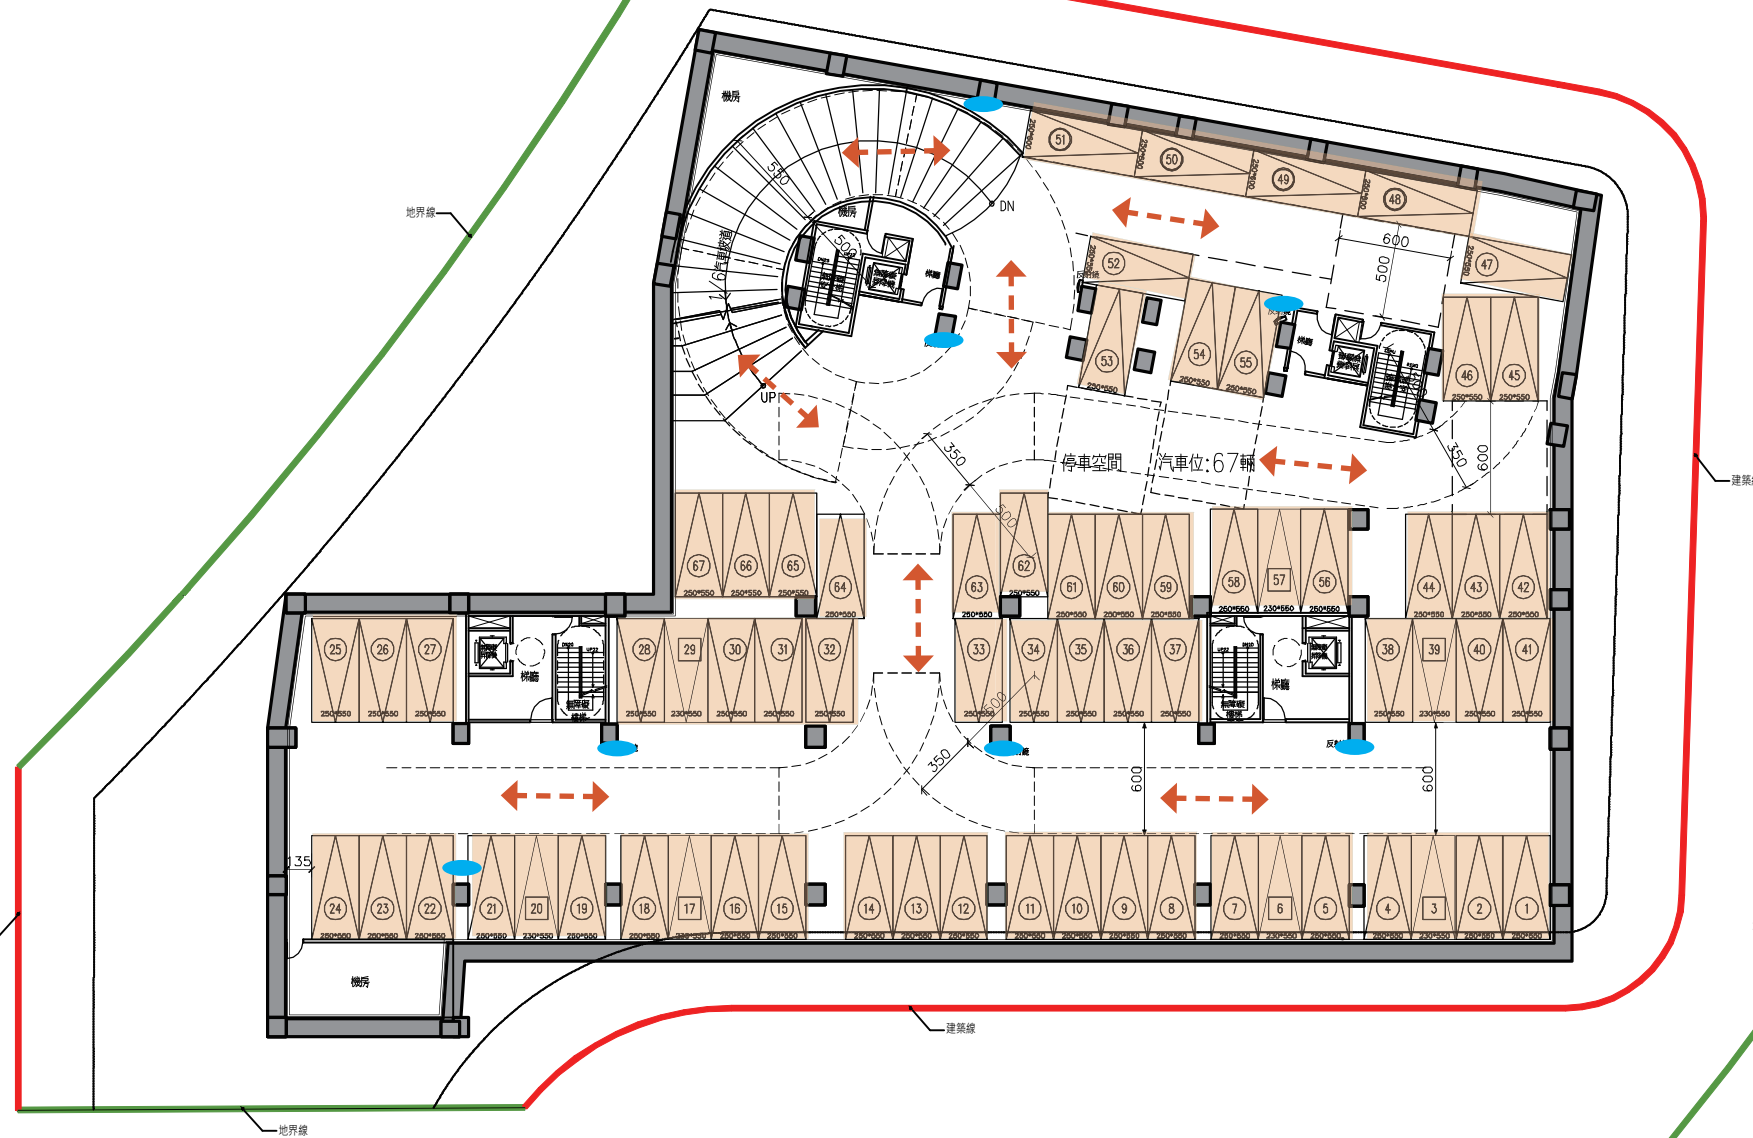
地下三層停車動線示意圖 SCALE: A3:1/400
